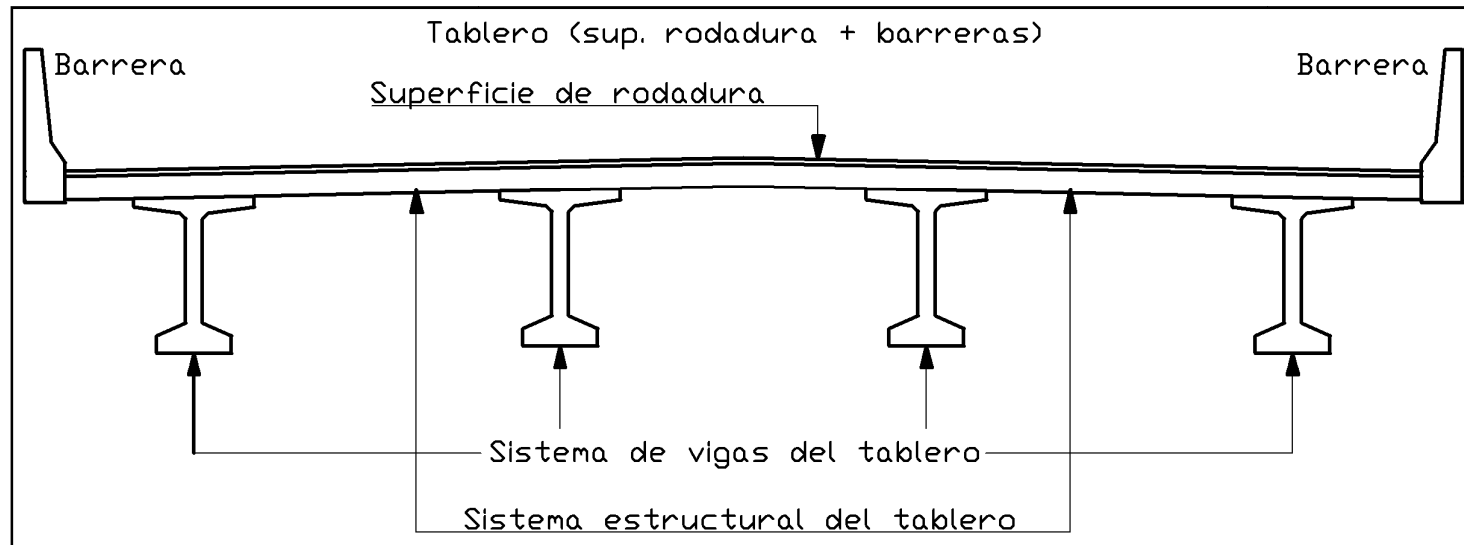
Sección transversal de la superestructura (perfil típico de puente con vigas de hormigón pretensado)
